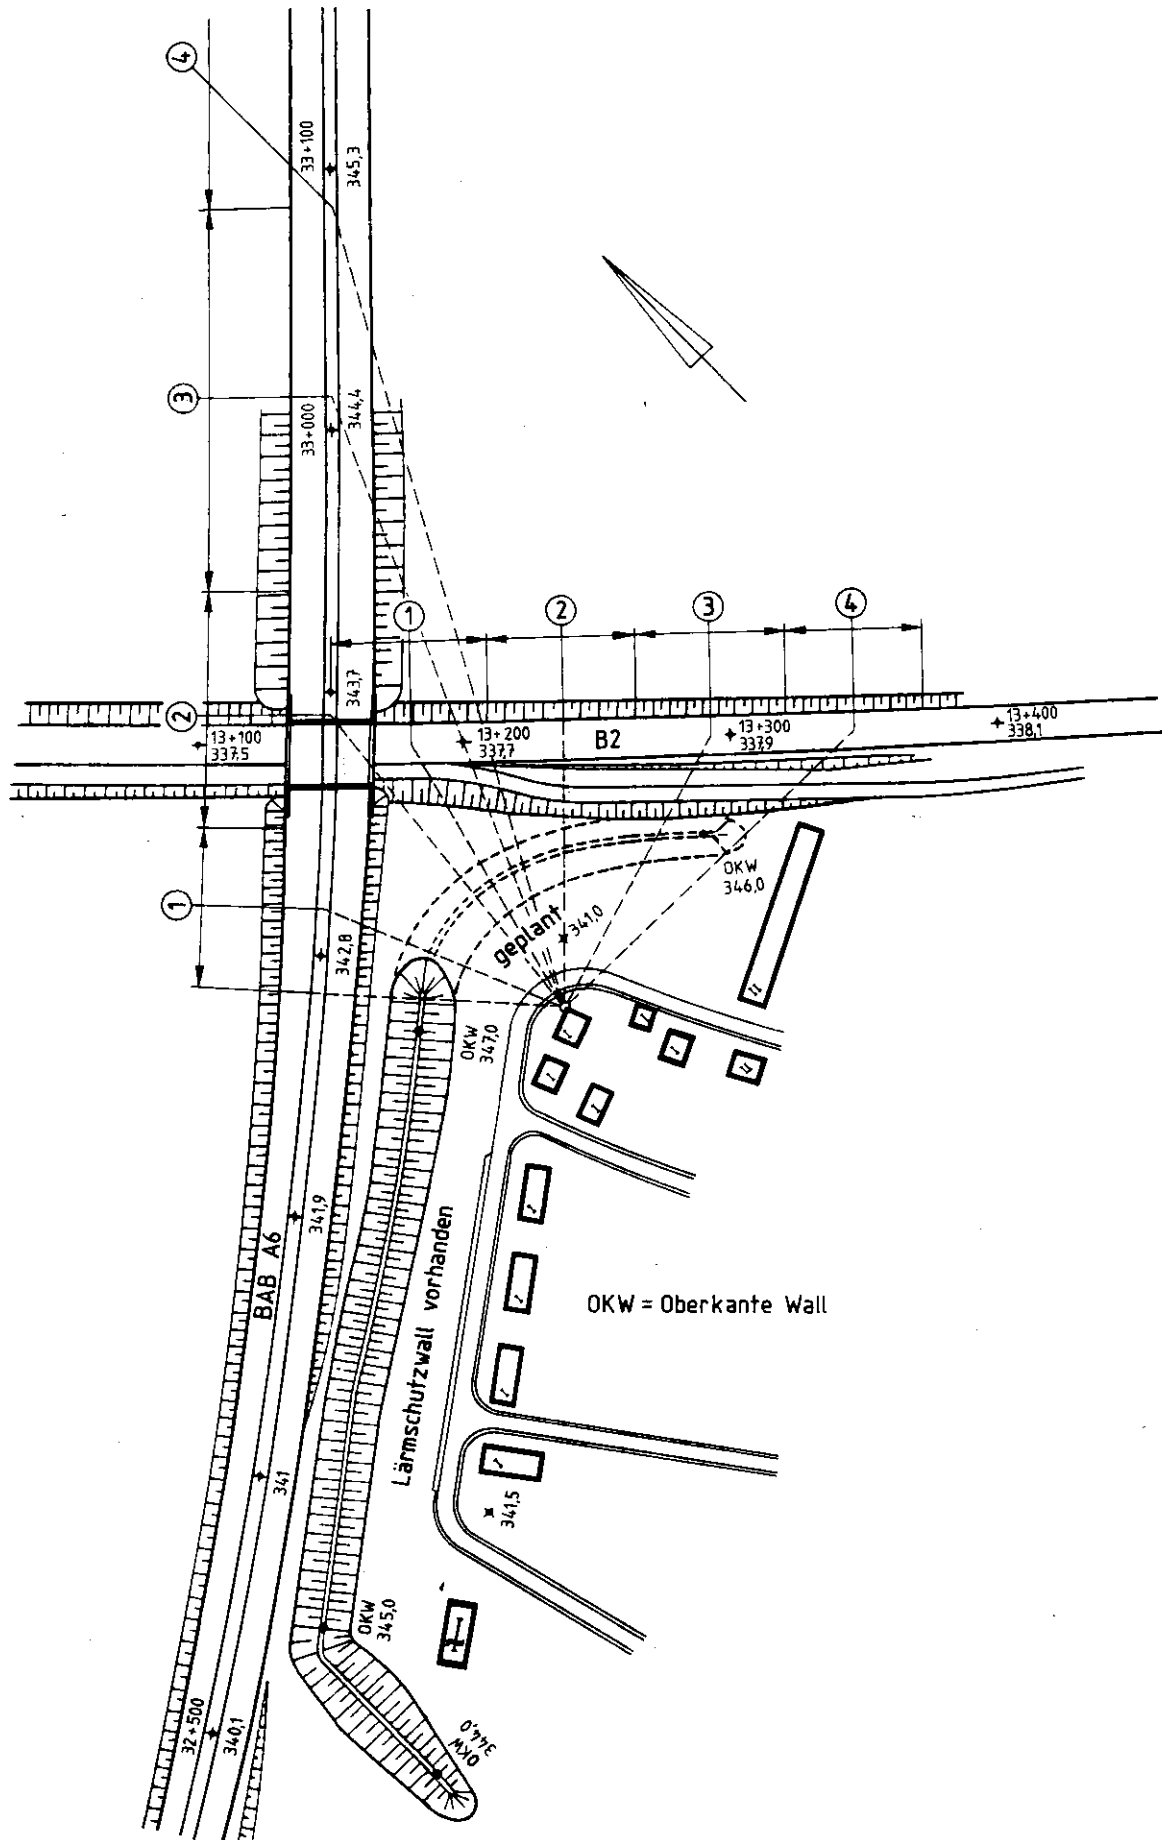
Baugebiet im Kreuzungsbereich einer Bundesautobahn und einer Bundesstraße (Lageplan)
